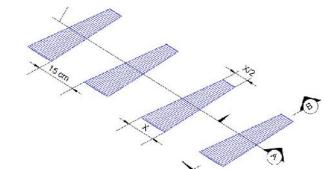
Vista isométrica de GSLF de tipo trapezoidal.
